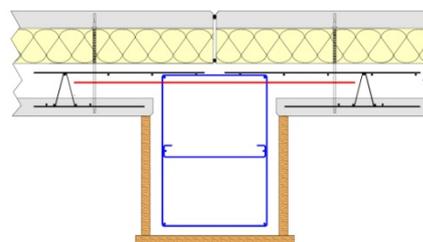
Poteau excentré coulé en place au droit d'un joint vertical
